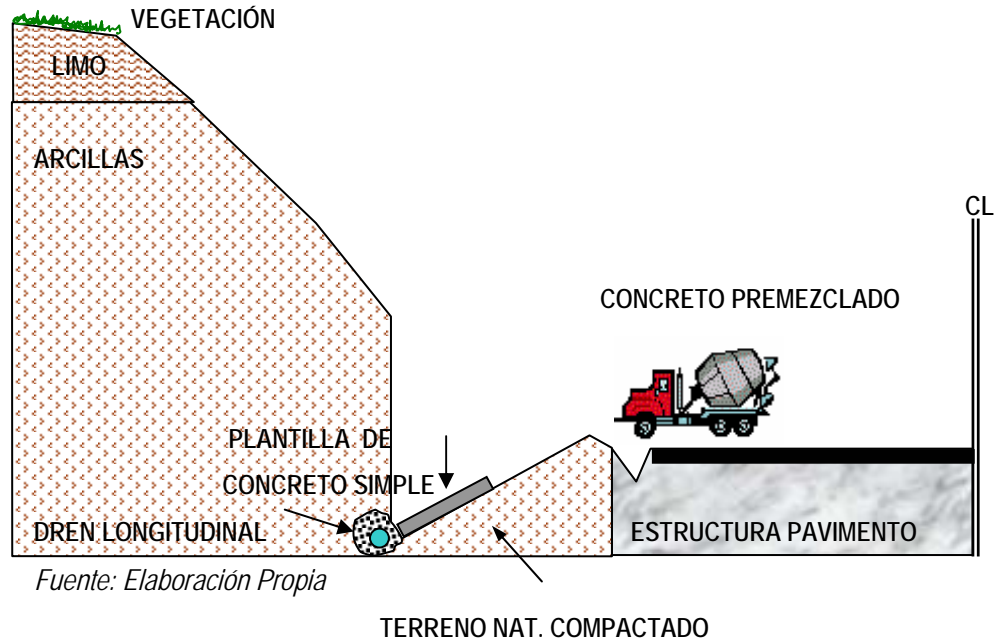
Croquis de la plantilla y del dren longitudinal.
